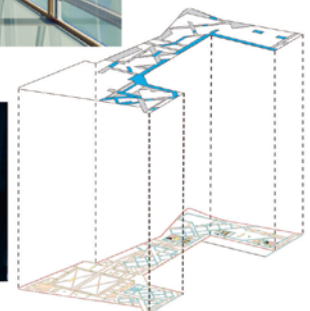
detail koridor lantai kaca Hasil Rancangan, 2014
